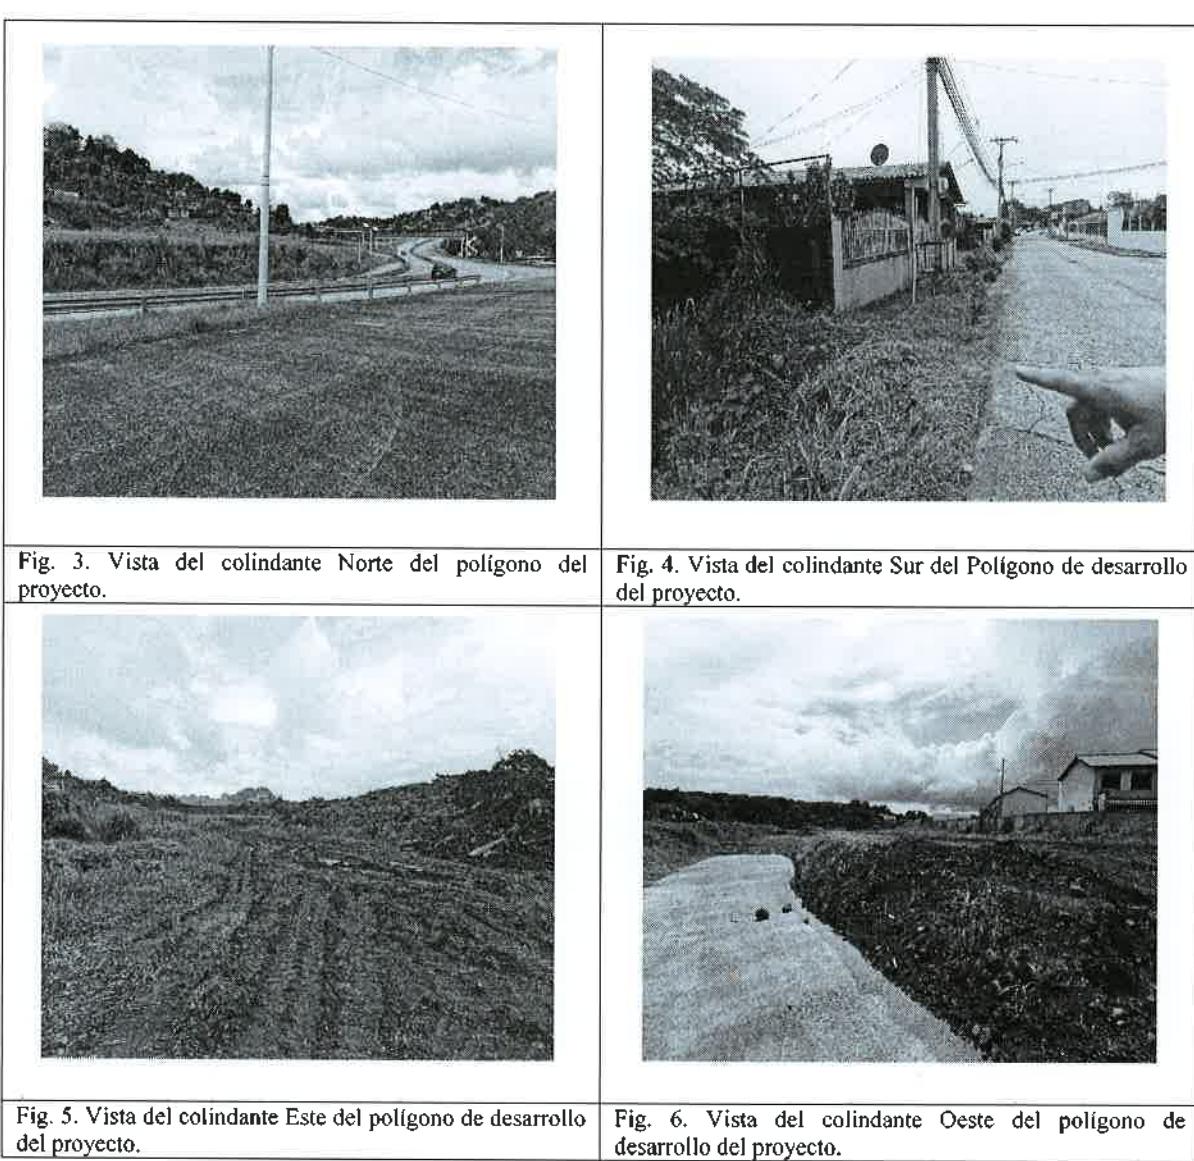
Vista del colindante Norte del polígono del proyecto.
